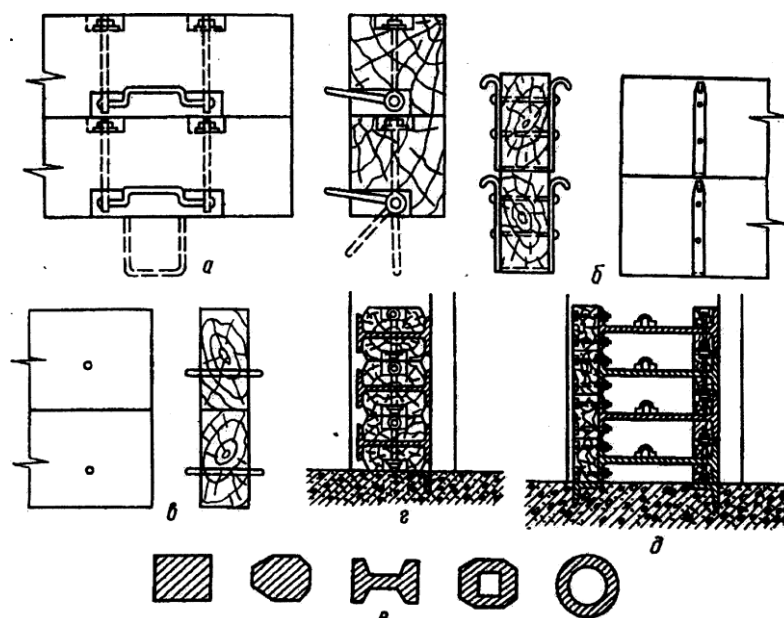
Шандоры: а,б,в, - деревянные; г,д - металлические; е - железобетонные.
